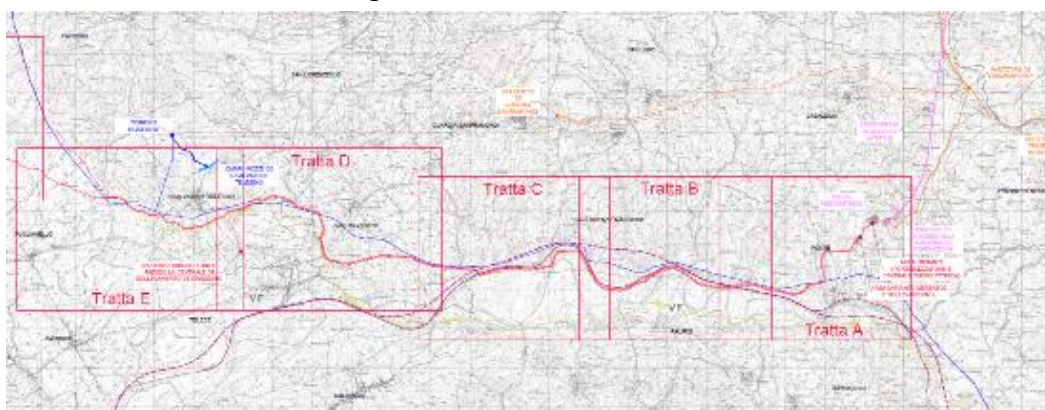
Planimetria condotta adduzione ACAM (in rosso)
